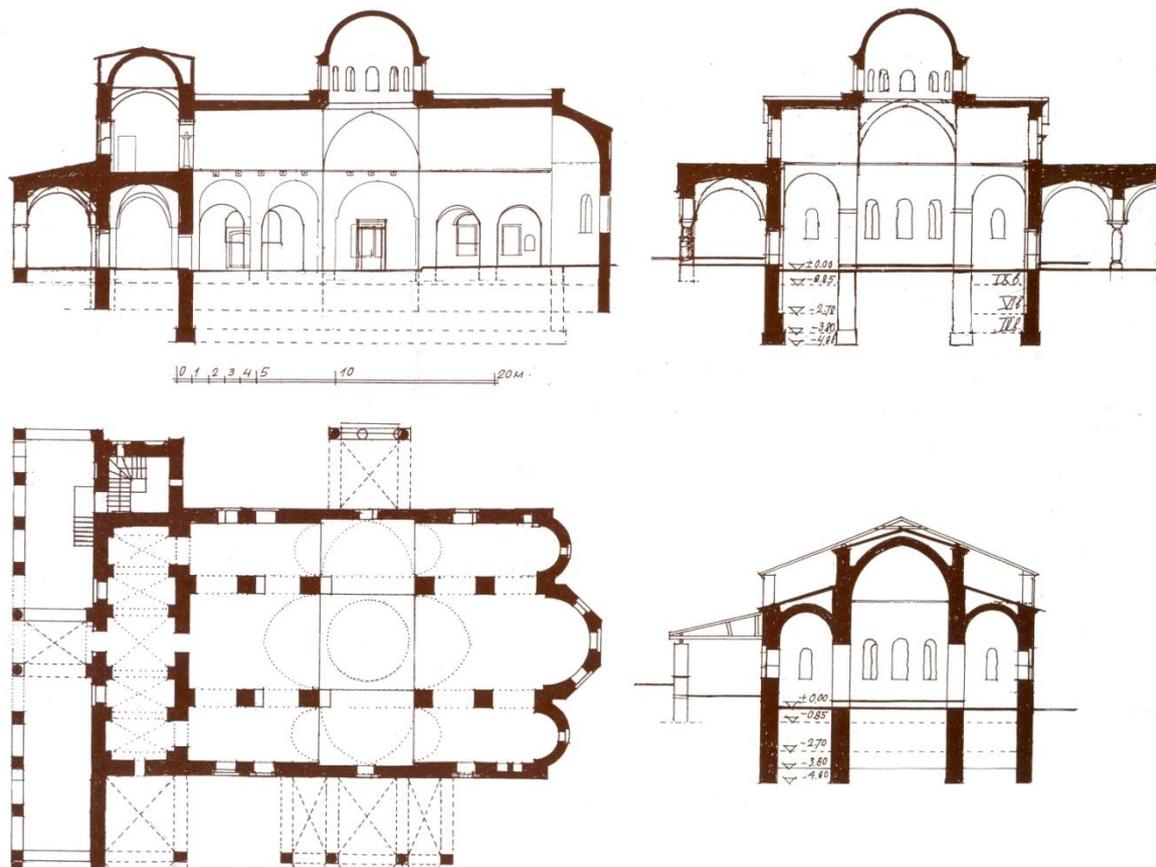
La catedral de Santa Sofía hacia la mitad del s. XI, con las fases de Samuel y León completas. Planta y secciones. Reconstrucción según Boris Chipan.
